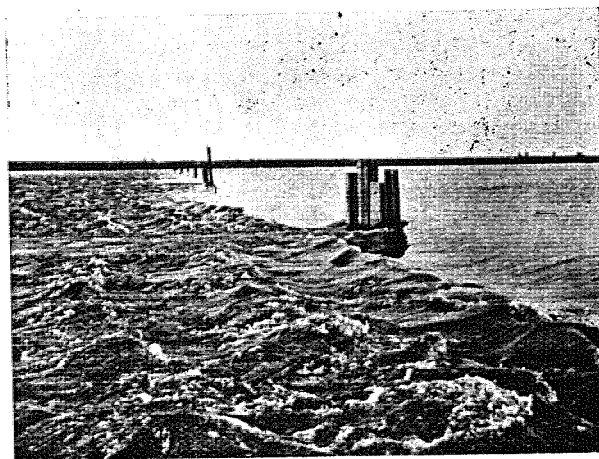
Photo prise de l'aval vers la Grande Ile Mateba. Palplanche haute d'avant plan n°s 537-534. Palplanche haute du large n° 484.
